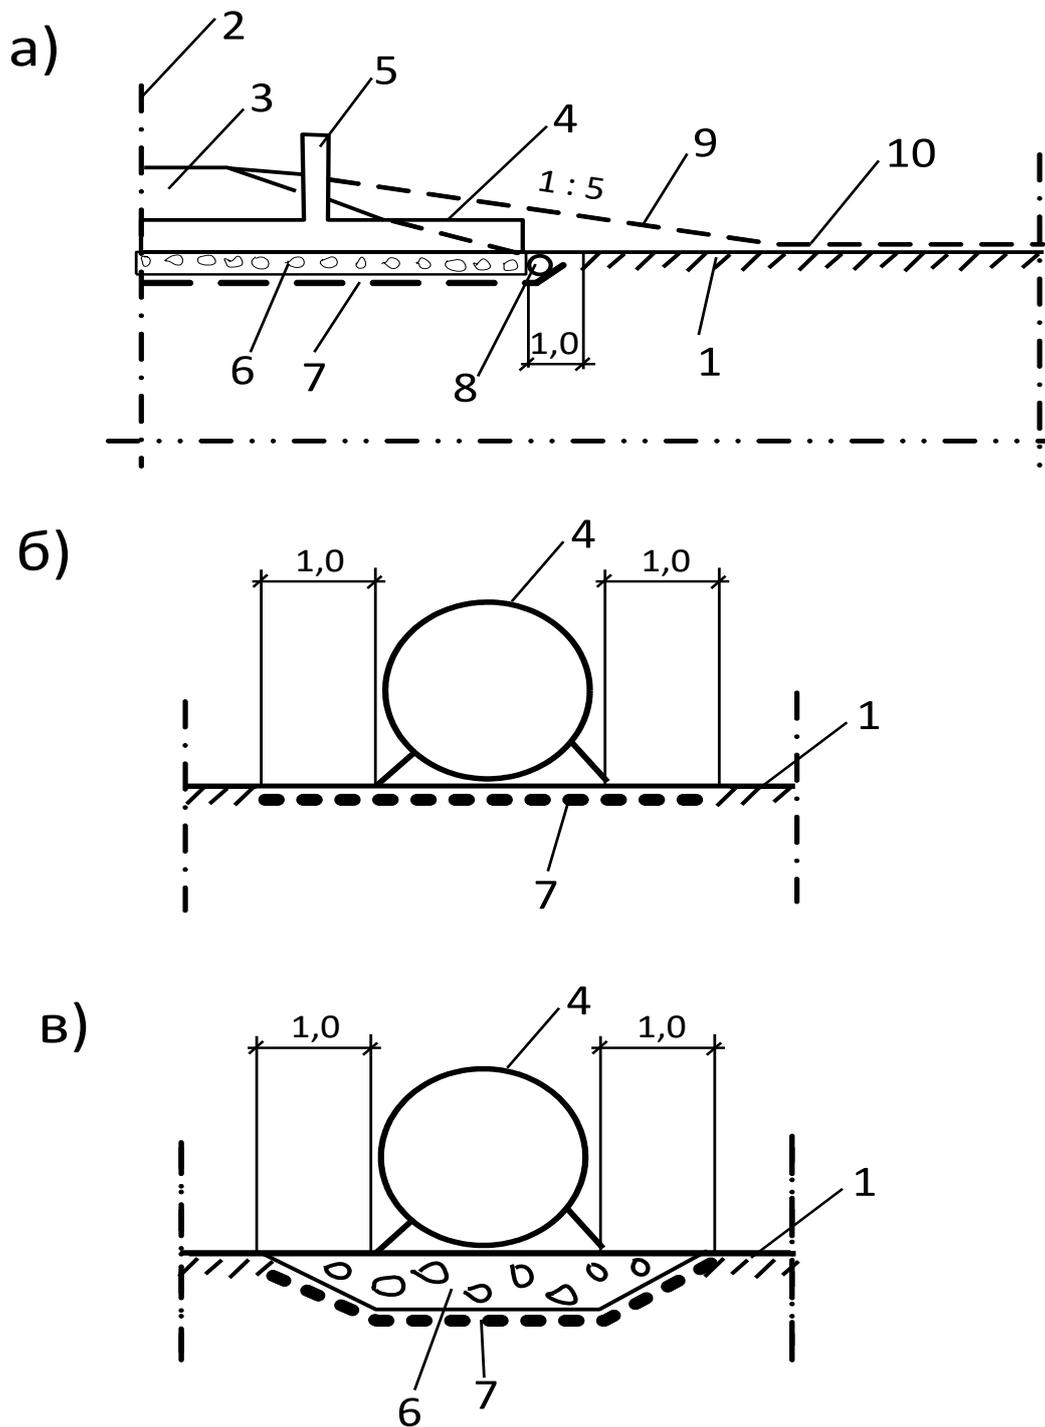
Принципиальная схема расположения термоизоляции в зоне тела трубы: а – разрез трубы по продольной оси, б,в – схемы расположения теплоизоляции соответственно без фильтрующей прослойки и с фильтрующей прослойкой, 1 – естественная поверхность грунта, 2 – ось насыпи, 3 – тело насыпи, 4 – тело водопропускной трубы, 5 – охлаждающий продух, 6 – фильтрующая прослойка, 7 – теплоизоляция, 8 – поперечная труба (лоток) – водосборник, 9,10 – снежные отложения соответственно в зоне трубы и в ненарушенной зоне.
